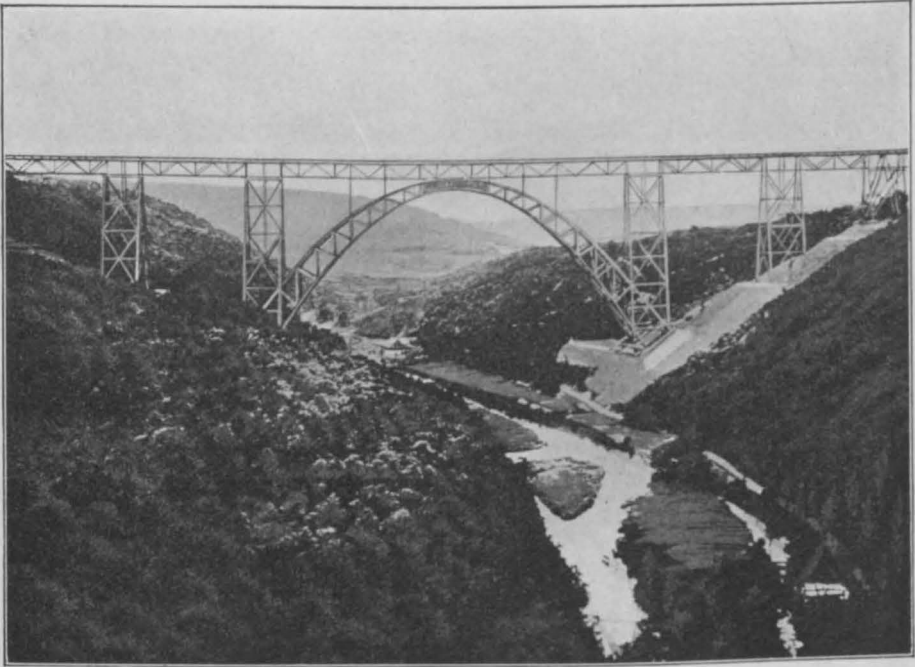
Kaiser Wilhelm-Brücke über das Wuppertal bei Müngsten.
